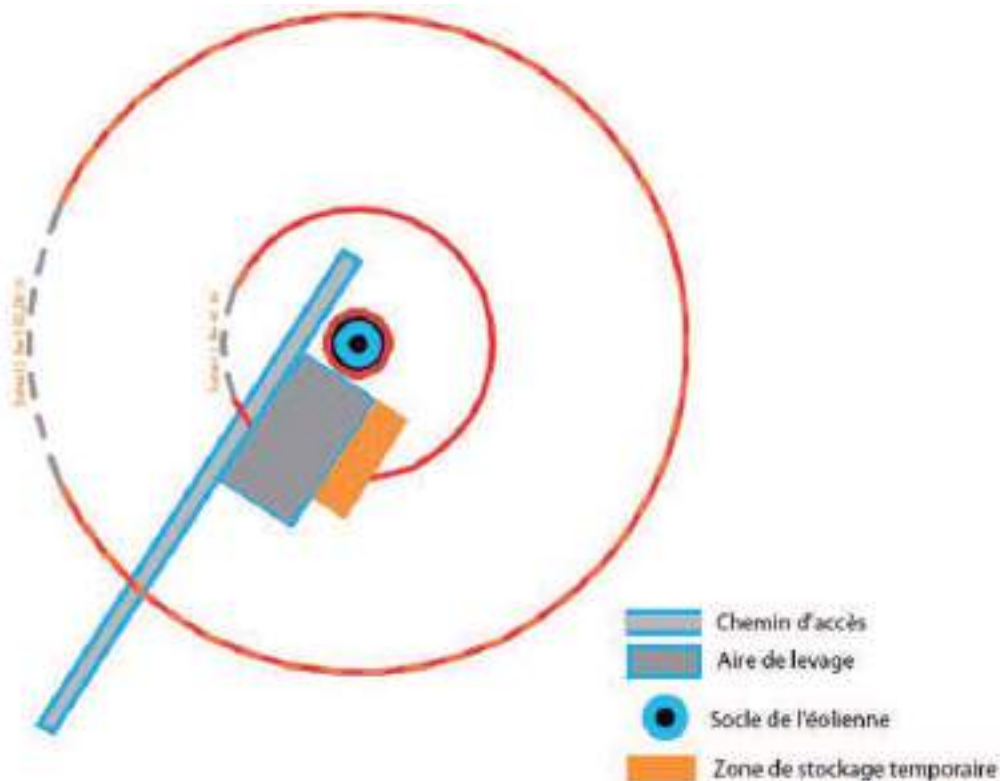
Exemple de plan d'une aire de levage et du pied d'éolienne
